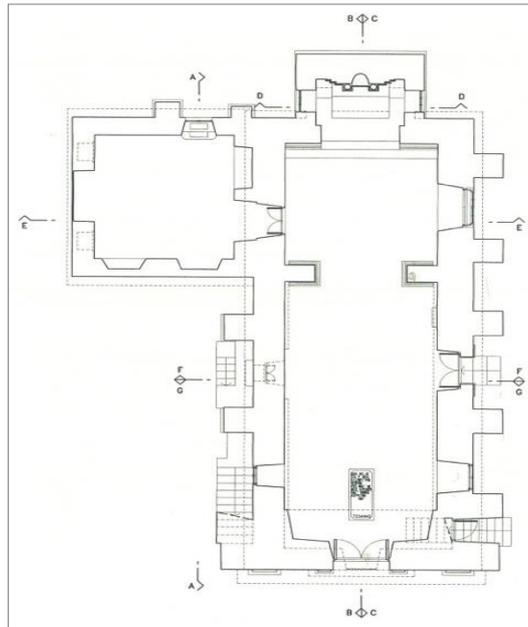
Planta da Capela de Nossa Senhora da Guia.
